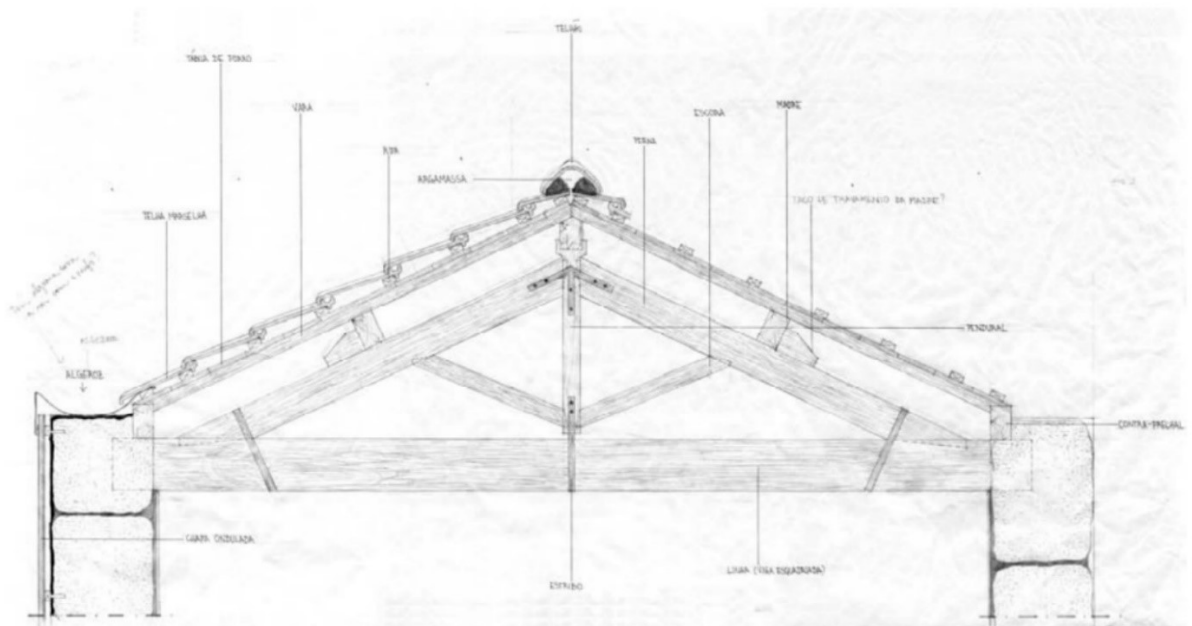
Desenho da estrutura de cobertura com telha Marselha fixa em ripado e com tabuado.
